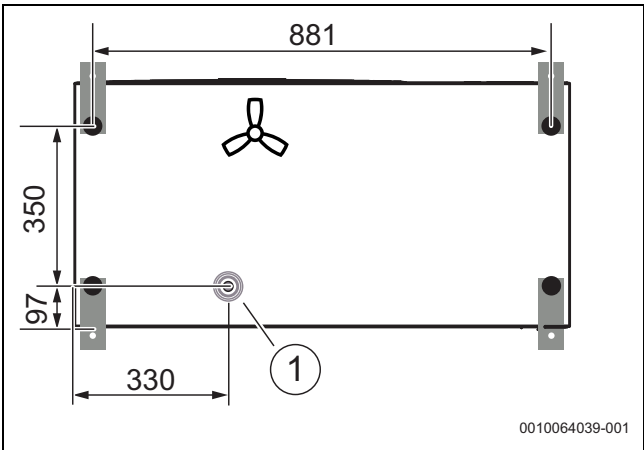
Distanze dal tronchetto di scarico, vista inferiore
